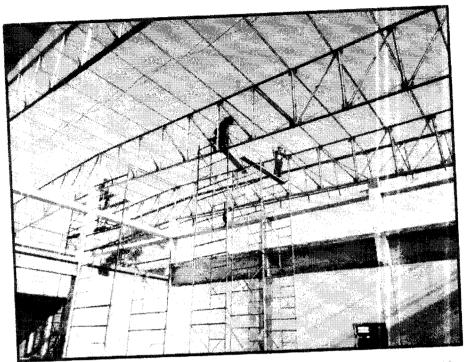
estructura metálica (vigetas) habilitada para instalación de cobertura de eternit.
